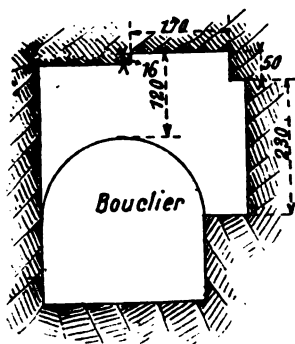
Chambre ouverte pour la réparation du bouclier.
